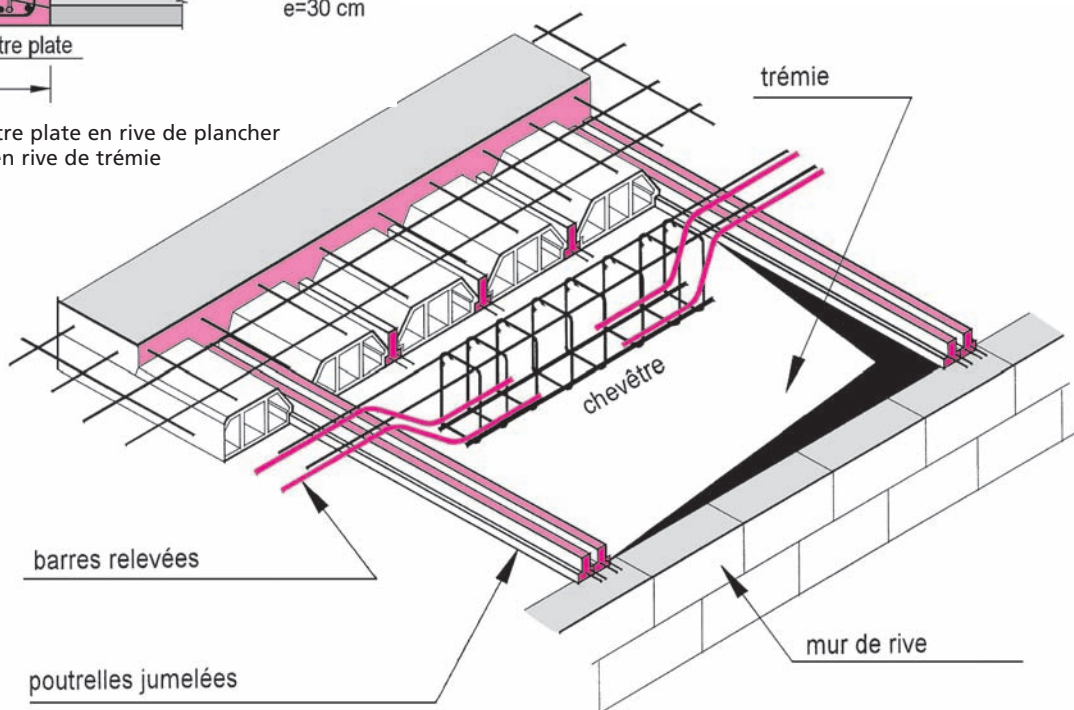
Chevêtre porteur des poutrelles dans le cas d'une trémie
